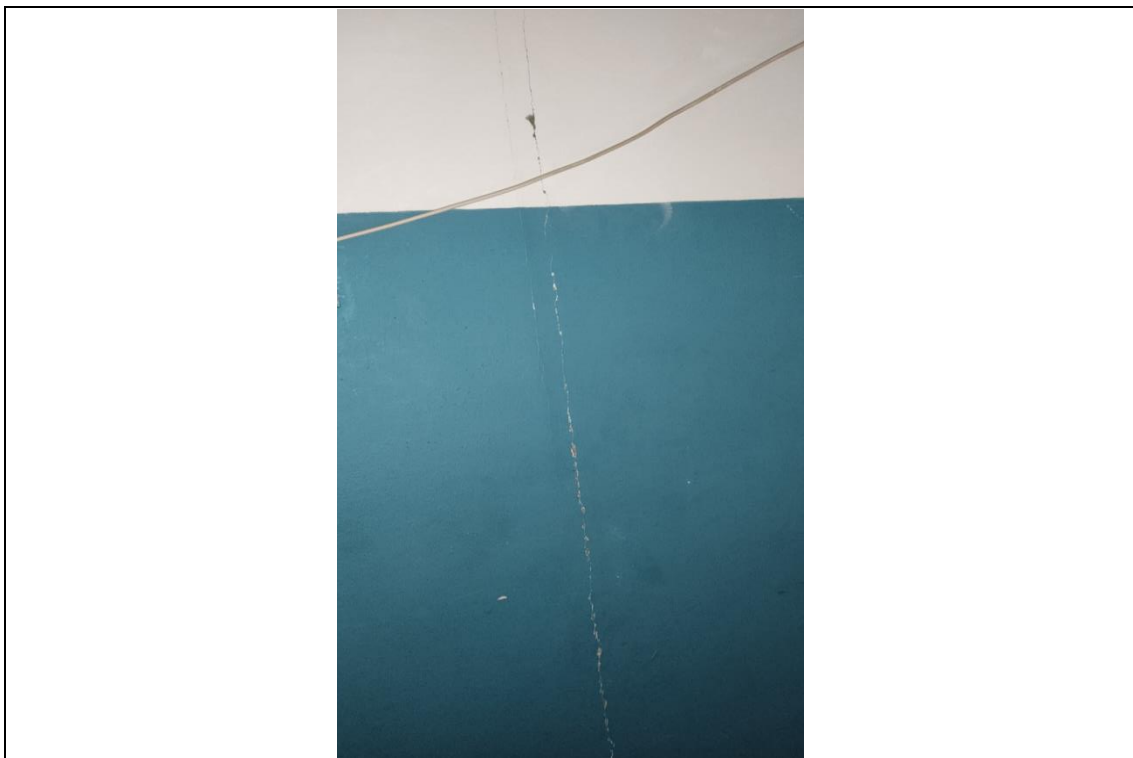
Вертикальная волосяная трещина на длиной более 250см на внутренней стене в здания в осях В/2-3
